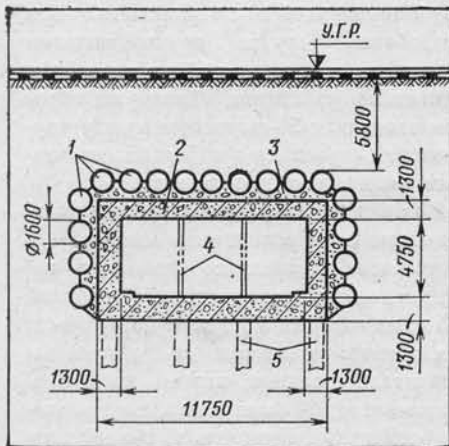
Схема экрана из труб над автодорожным тоннелем:
